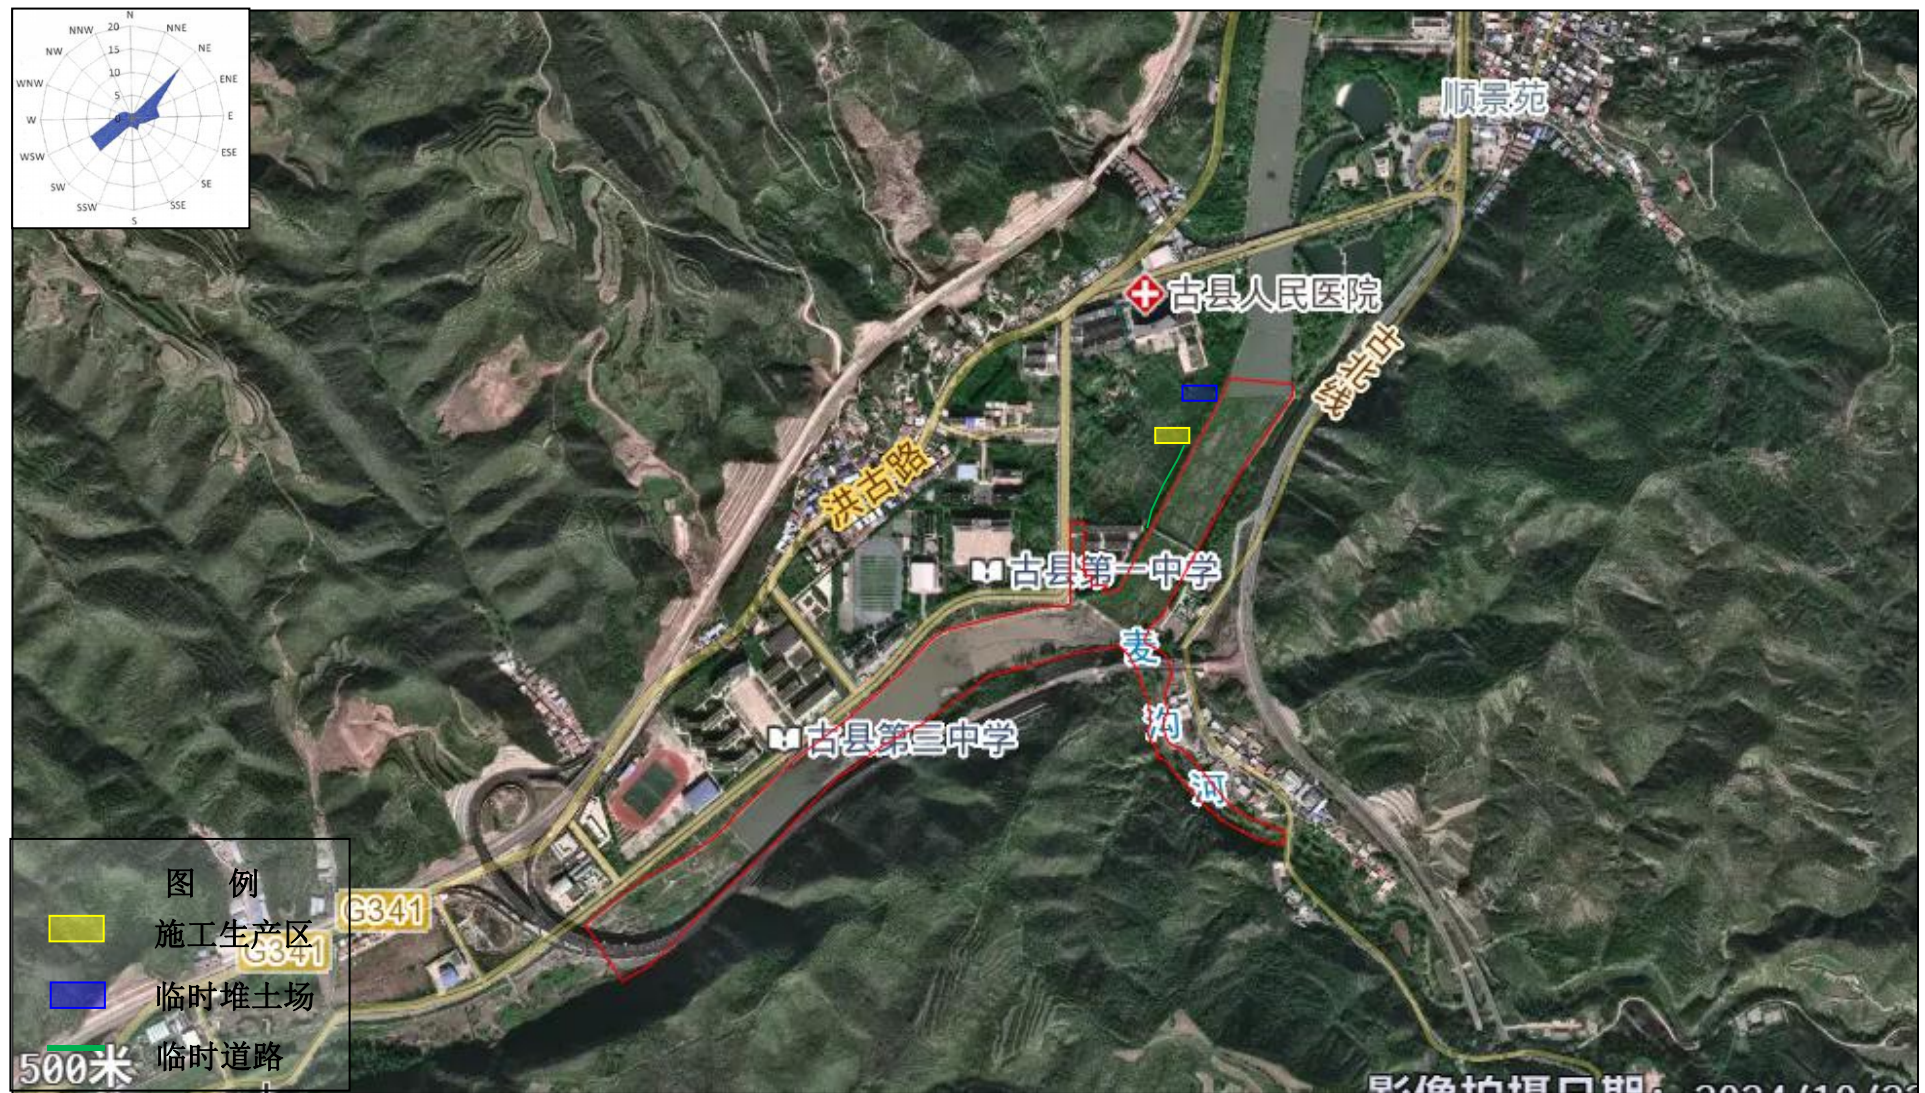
(2) 施工平面布置示意图 (山青水镜段)
